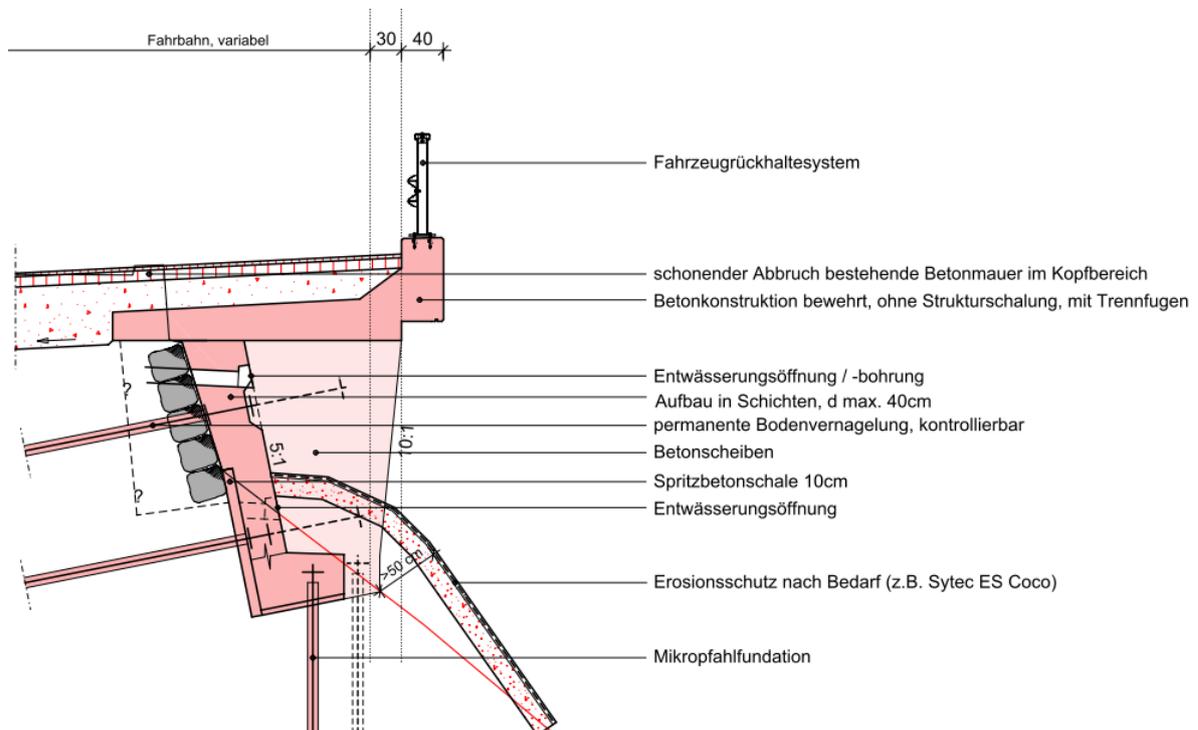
Normalprofil T 3 – Neubau Lehenkonstruktion
